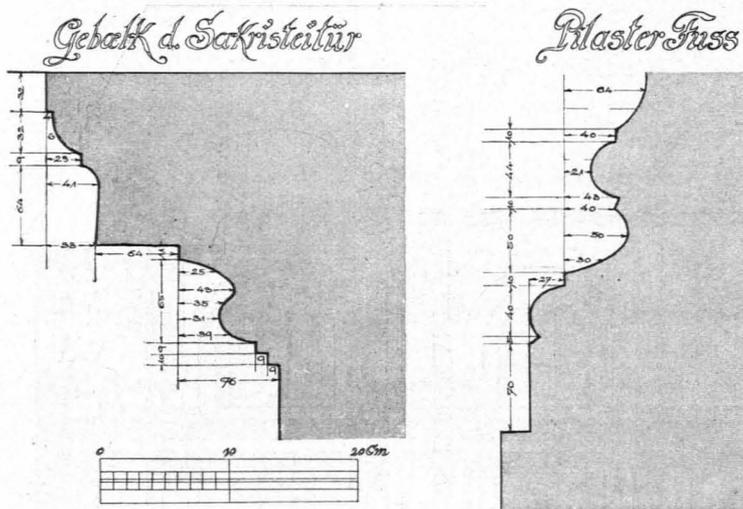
Säusenstein, Pfarrkirche, Architektonisches Detail (S. 408)
